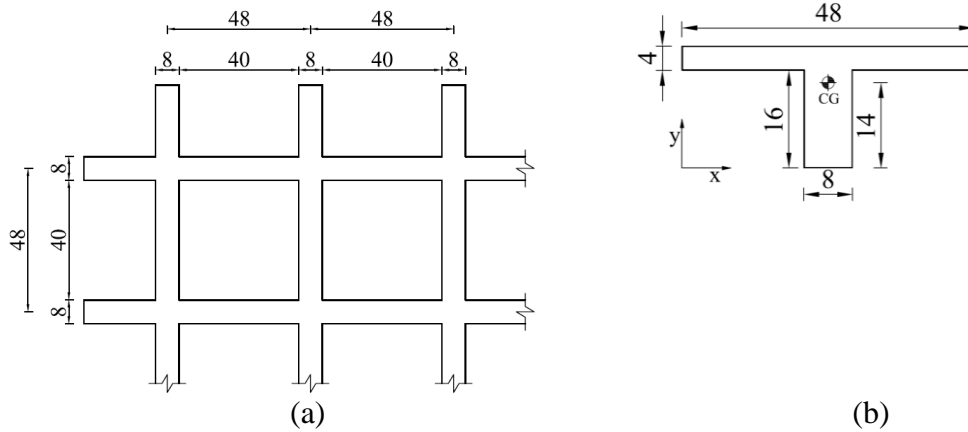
Detalhamento da laje nervurada (a) e seção transversal da nervura (b) – unidades em cm.
